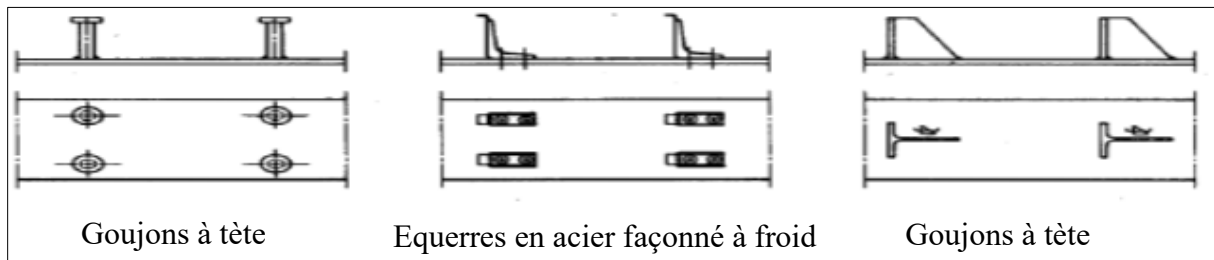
Exemple des connecteurs utilisés dans les sections mixtes acier-béton.
